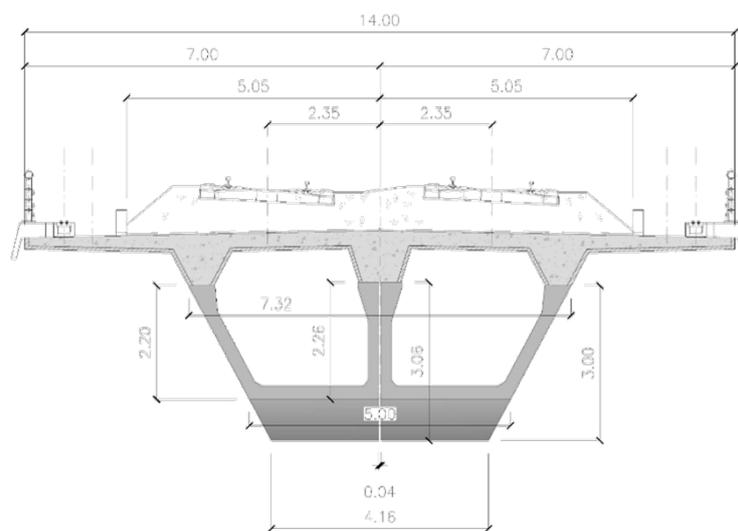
Imagen de puente para línea AVE con vigas adosadas y placa realizada, vano central 60 m.
